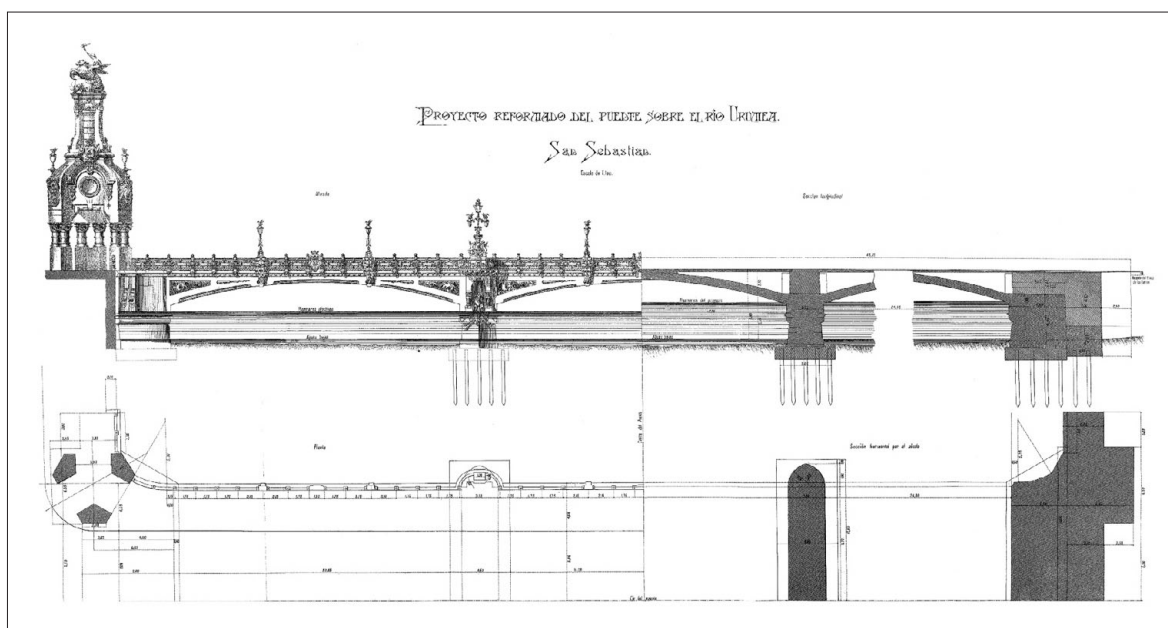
Puente sobre el río Urumea / Puente de María Cristina (Planos). Eugenio Ribera y Julio M. Zapata, 1904. *ROP*, 1904.
